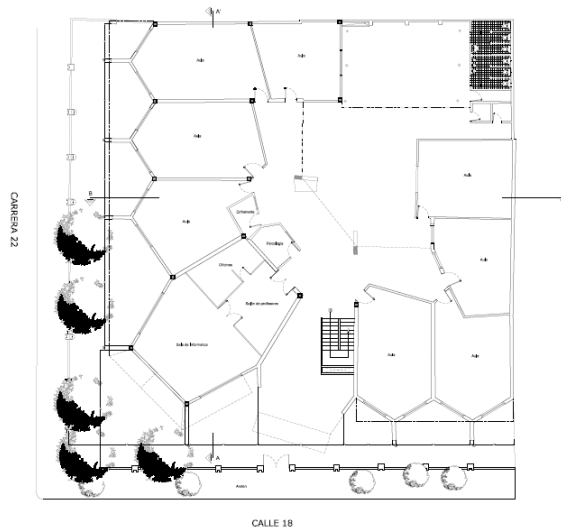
Planta Arquitectónica 1er Piso. CAJAMAG.
